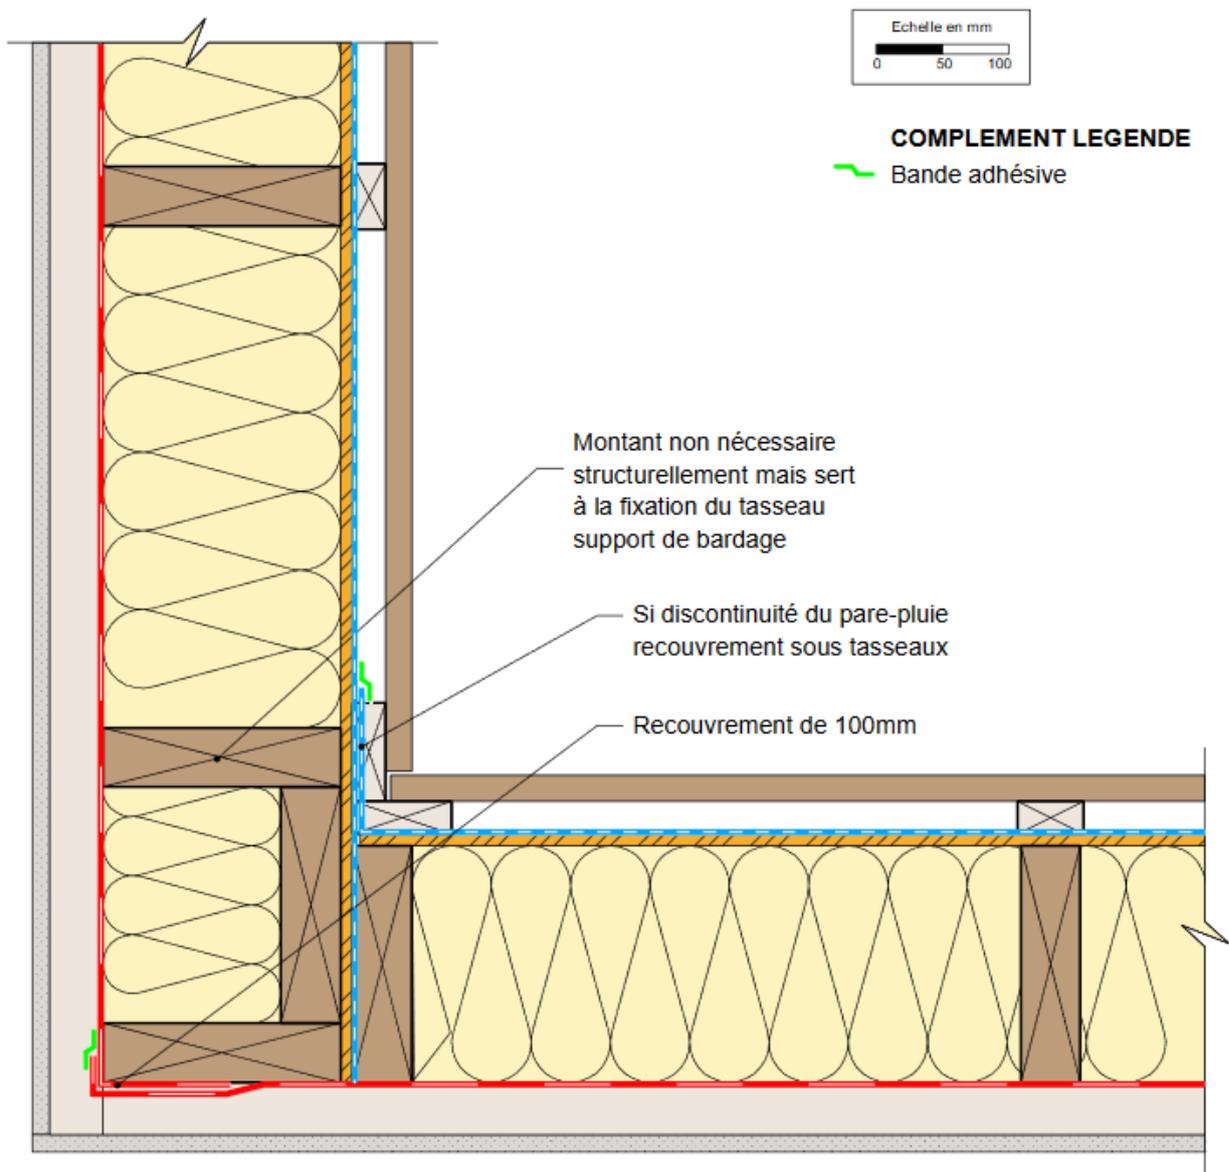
Exemple d'un angle rentrant avec simple recouvrement collé (coupe horizontale)
